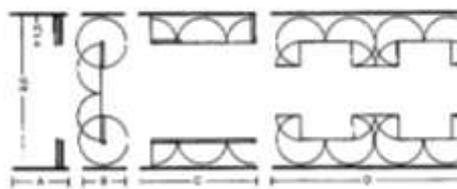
3 Ruang dengan Ukuran yang Baik
